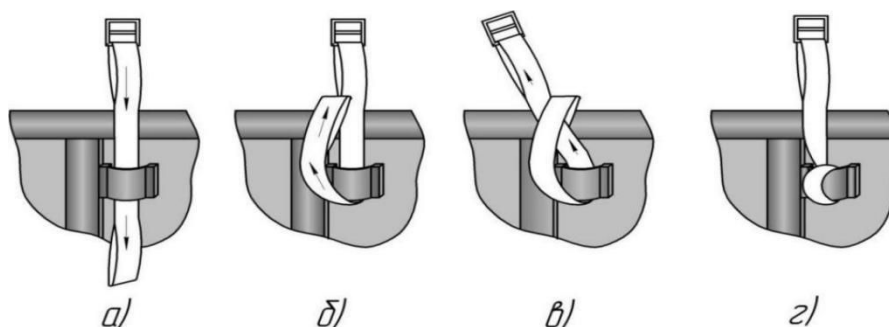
Установка прижимных модулей креплений МВ КТБ5 7,0/700-7000
